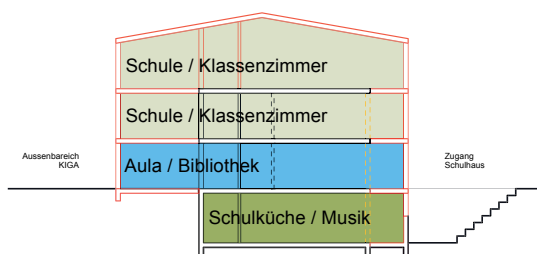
Grundrisse Schulhaus (Bearbeitungsteam)
